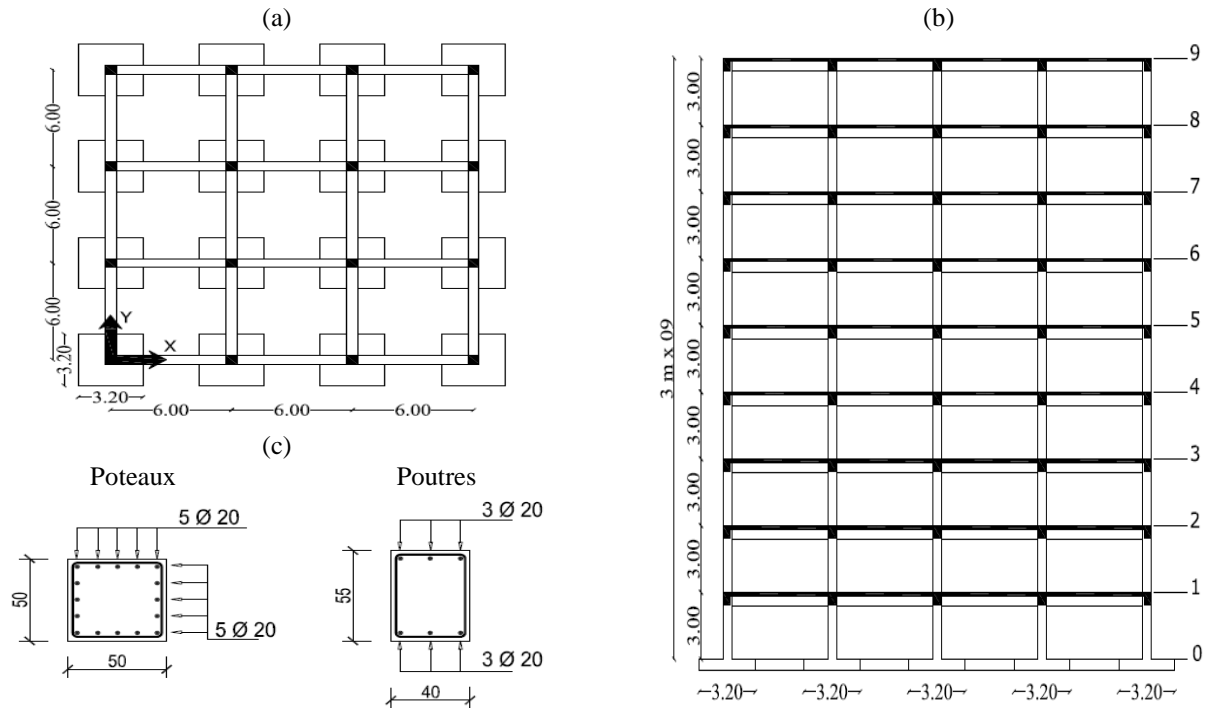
Vue en plan et en élévation de la structure de 9 niveaux
